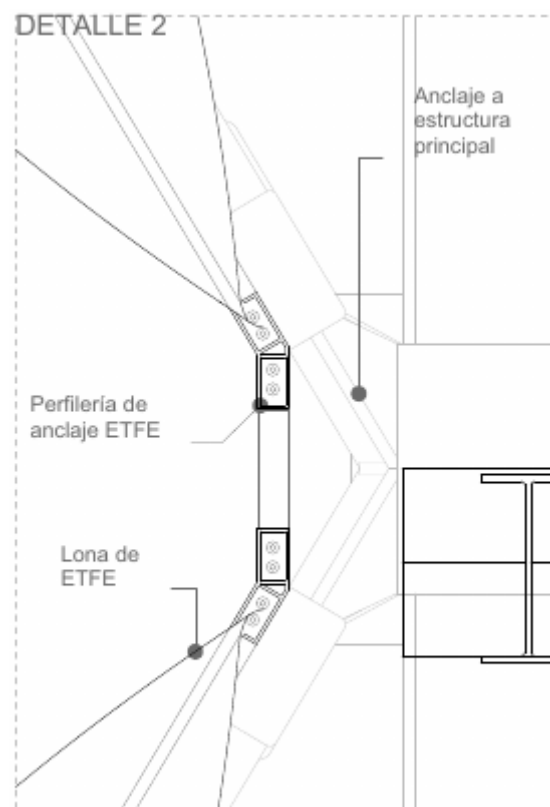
Detalle 2 de unión de perfilaría con lona de ETFE, Fuente: Elaboración propia
